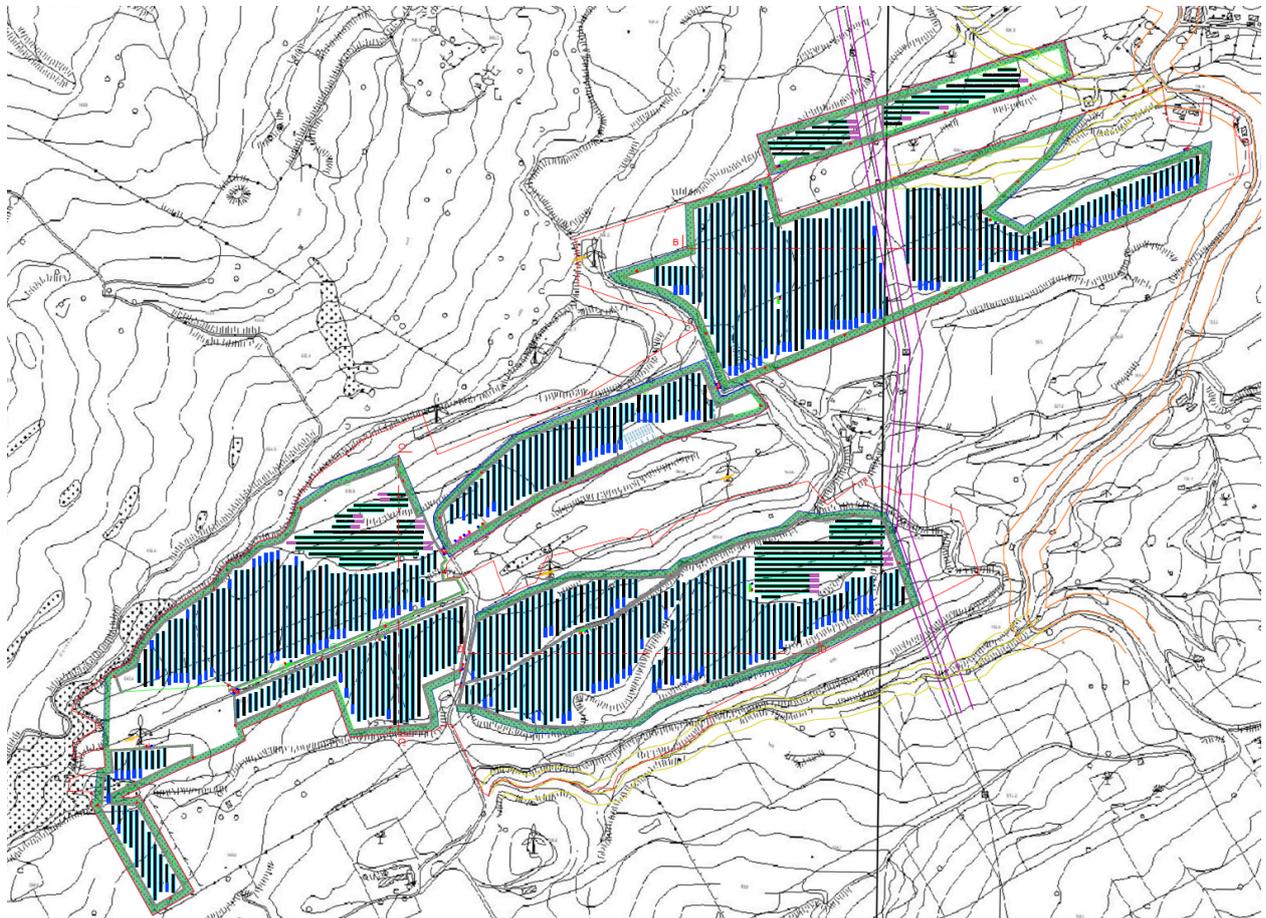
Planimetria e indicazioni delle sezioni – sottocampo 2, 3, 4, 5
